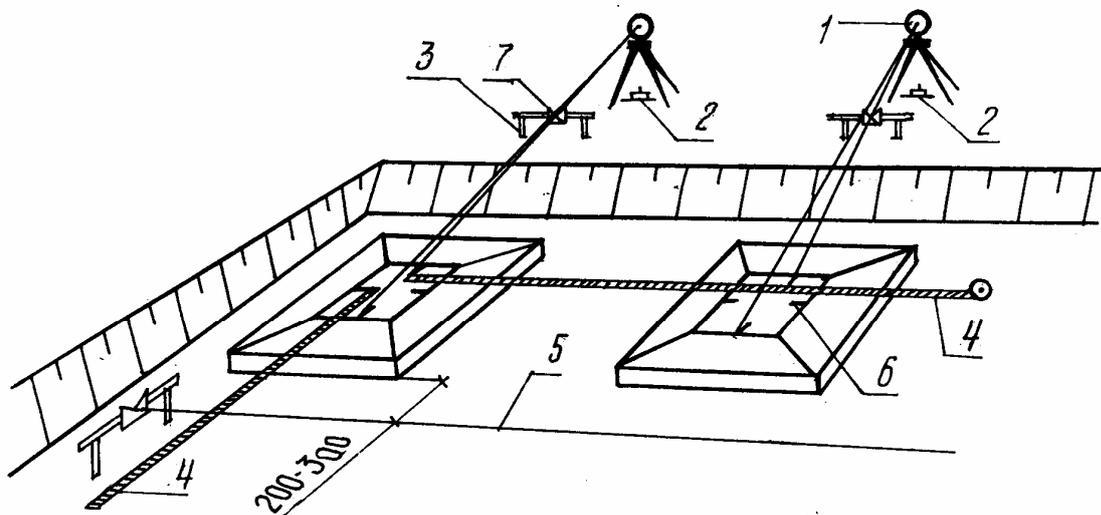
Схема перенесения осей фундамента в котлован с помощью теодолита:
